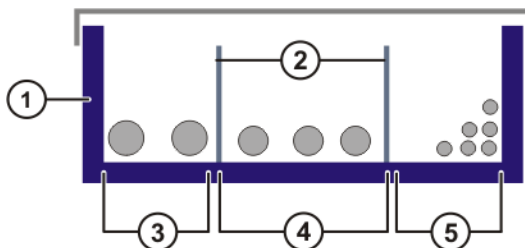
Ejemplo: Instalación de los cables en el canal para cables
